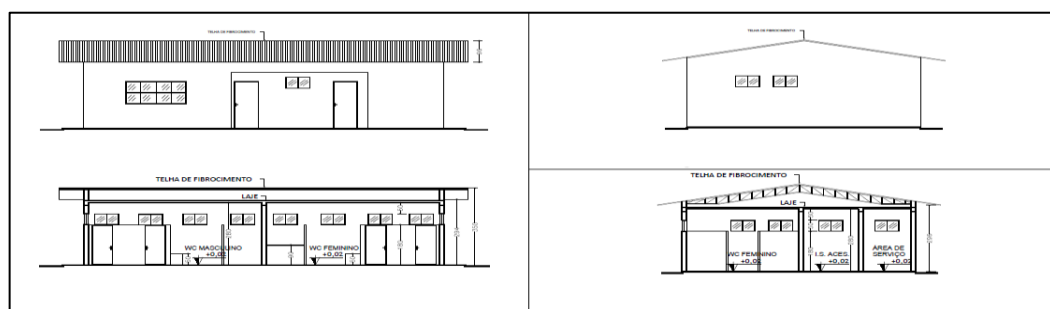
Cortes e fachadas no projeto conceitual da área de vivência
